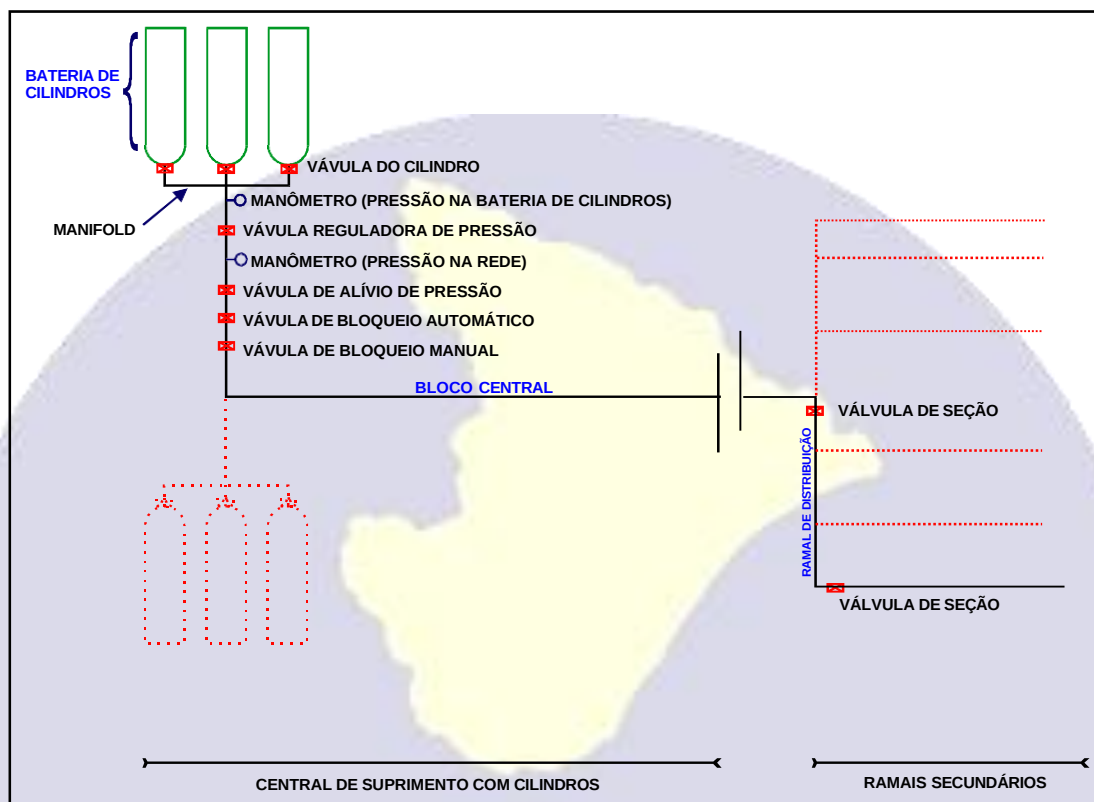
Central de Suprimento com Cilindros – Desenho Esquemático.
